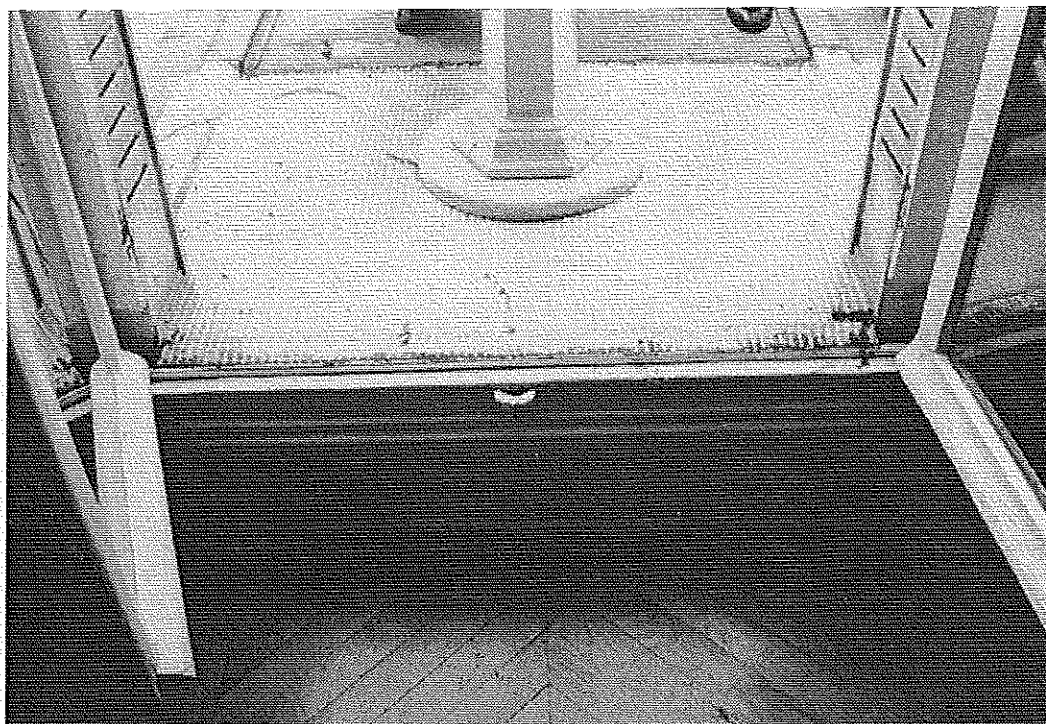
Raccordement d'étanchéité par chape bitumée à autoprotection métallique au droit d'une porte-fenêtre. Insuffisance du rejingot. © J. Putatti
